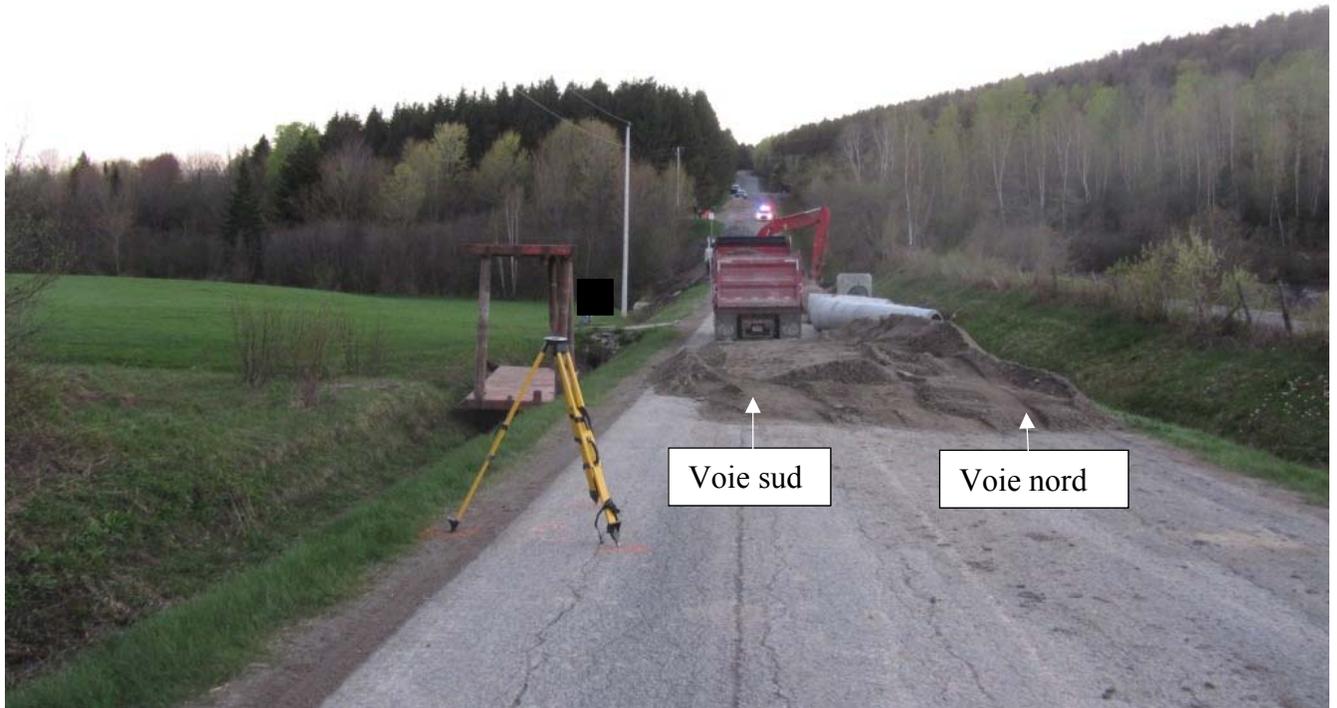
Déversement du camion sur toute la surface de la voie sud de la route
